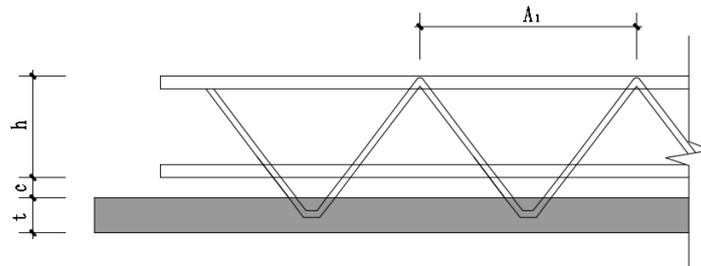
钢筋桁架保温楼承板截面构造示意
